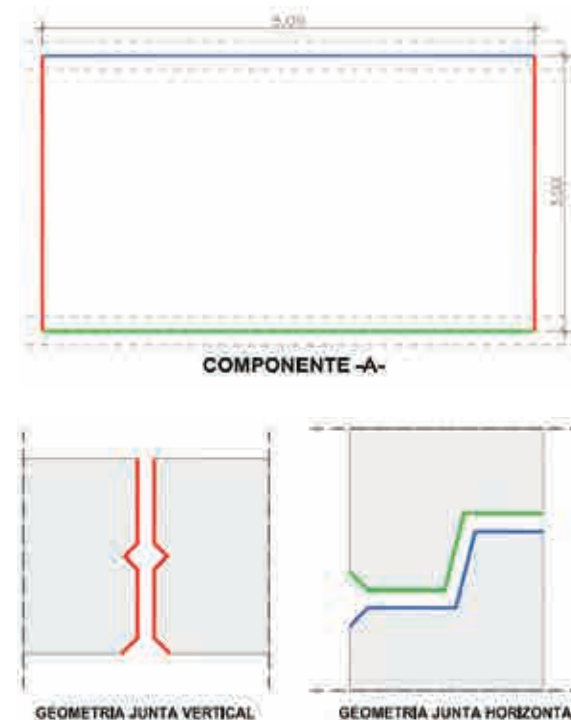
Geometría del componente plano v tipo de junta o borde perimetral
